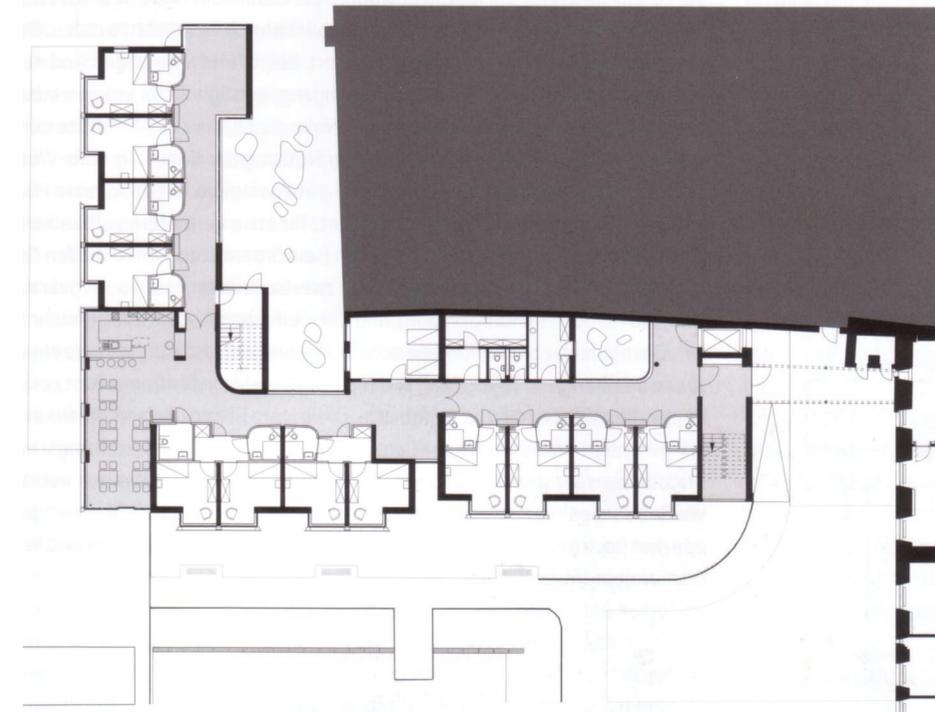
Grundriss Erdgeschoss M 1:500
